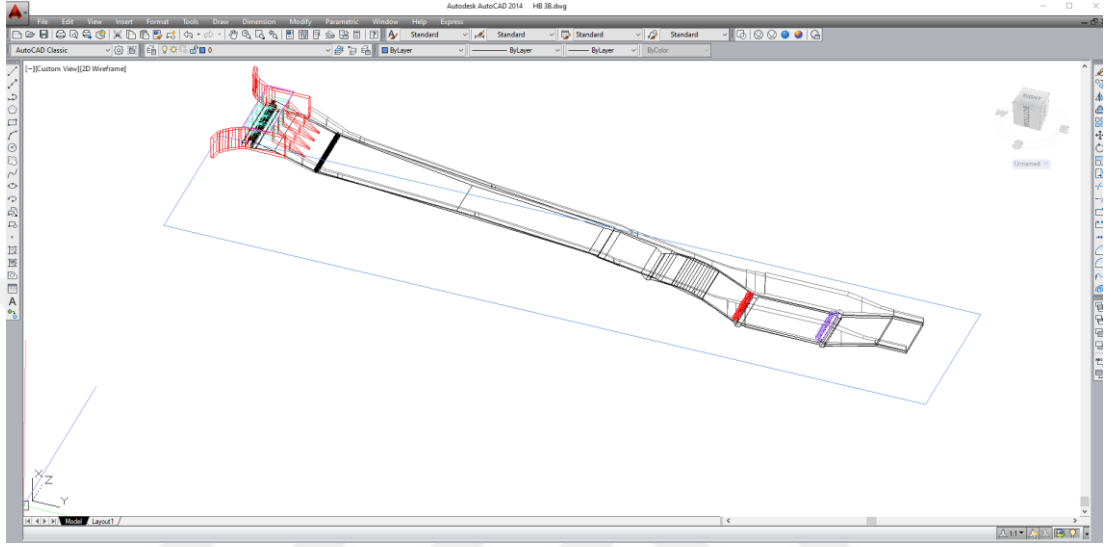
Dolusavak modeli Autocad 2 boyutlu yan profil çizim
